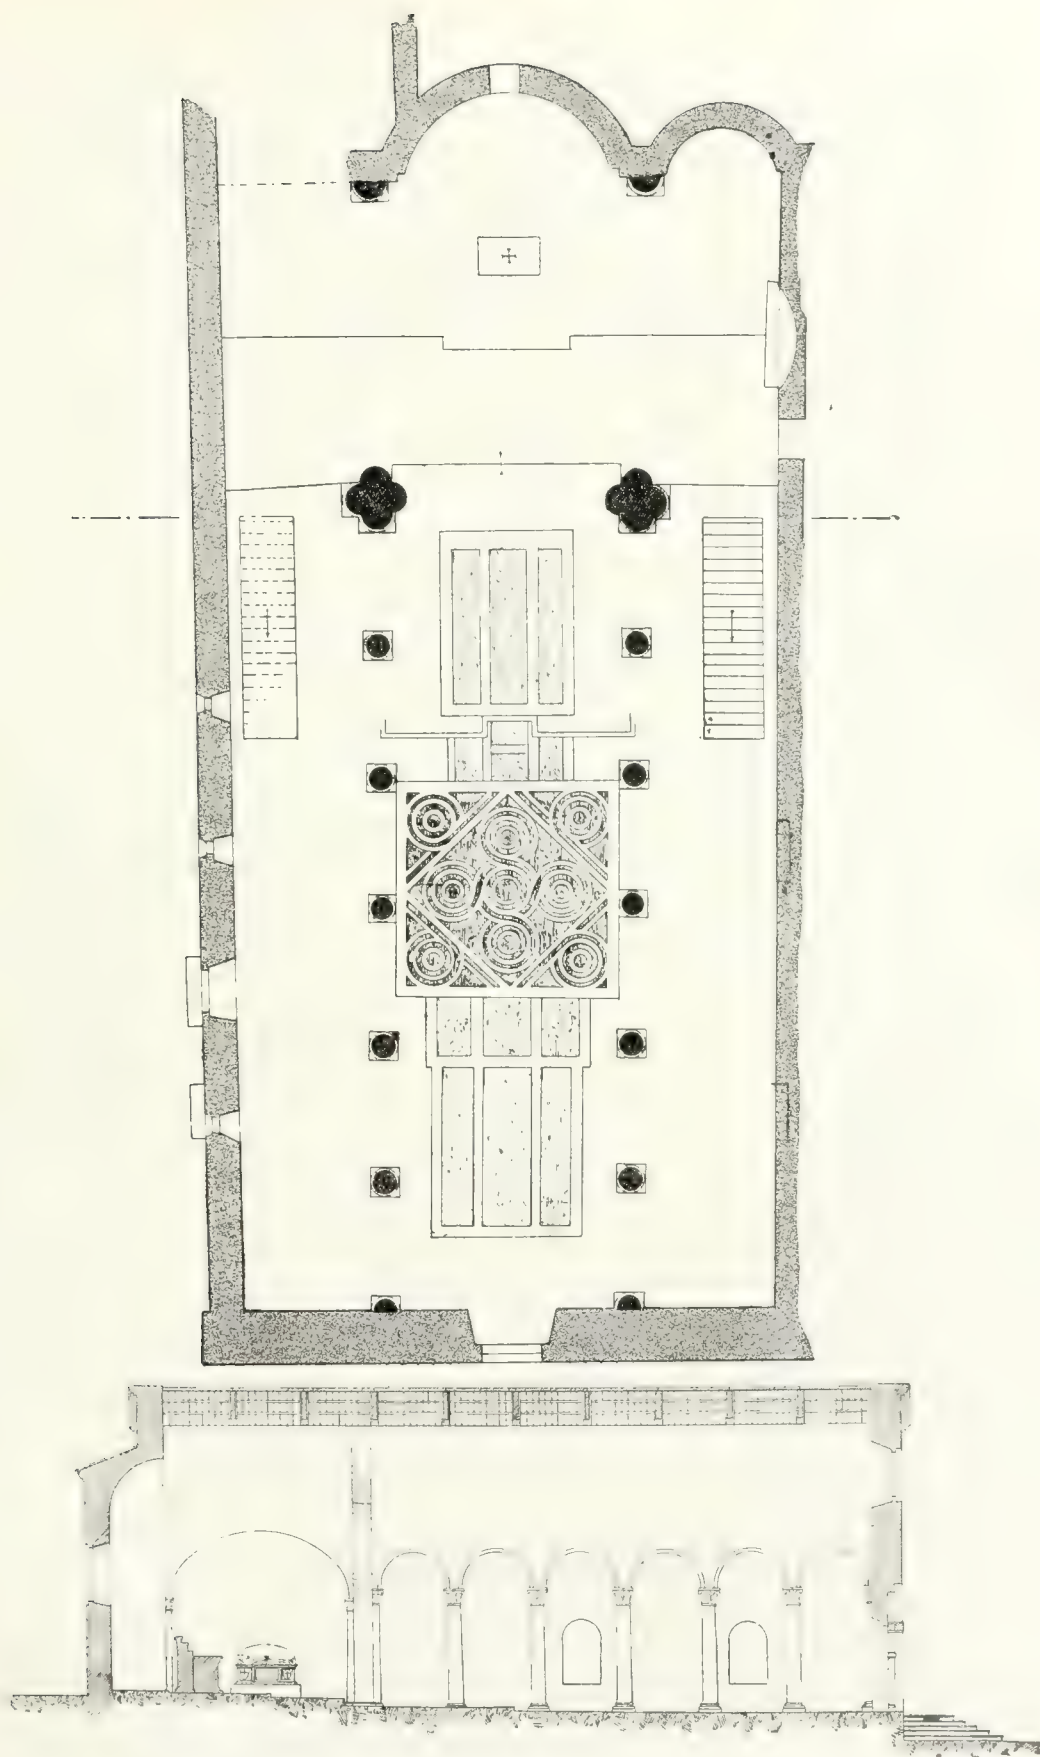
Pianta al piano del pavimento e sezione longitudinale. — *Vetrala*, San Francesco.
